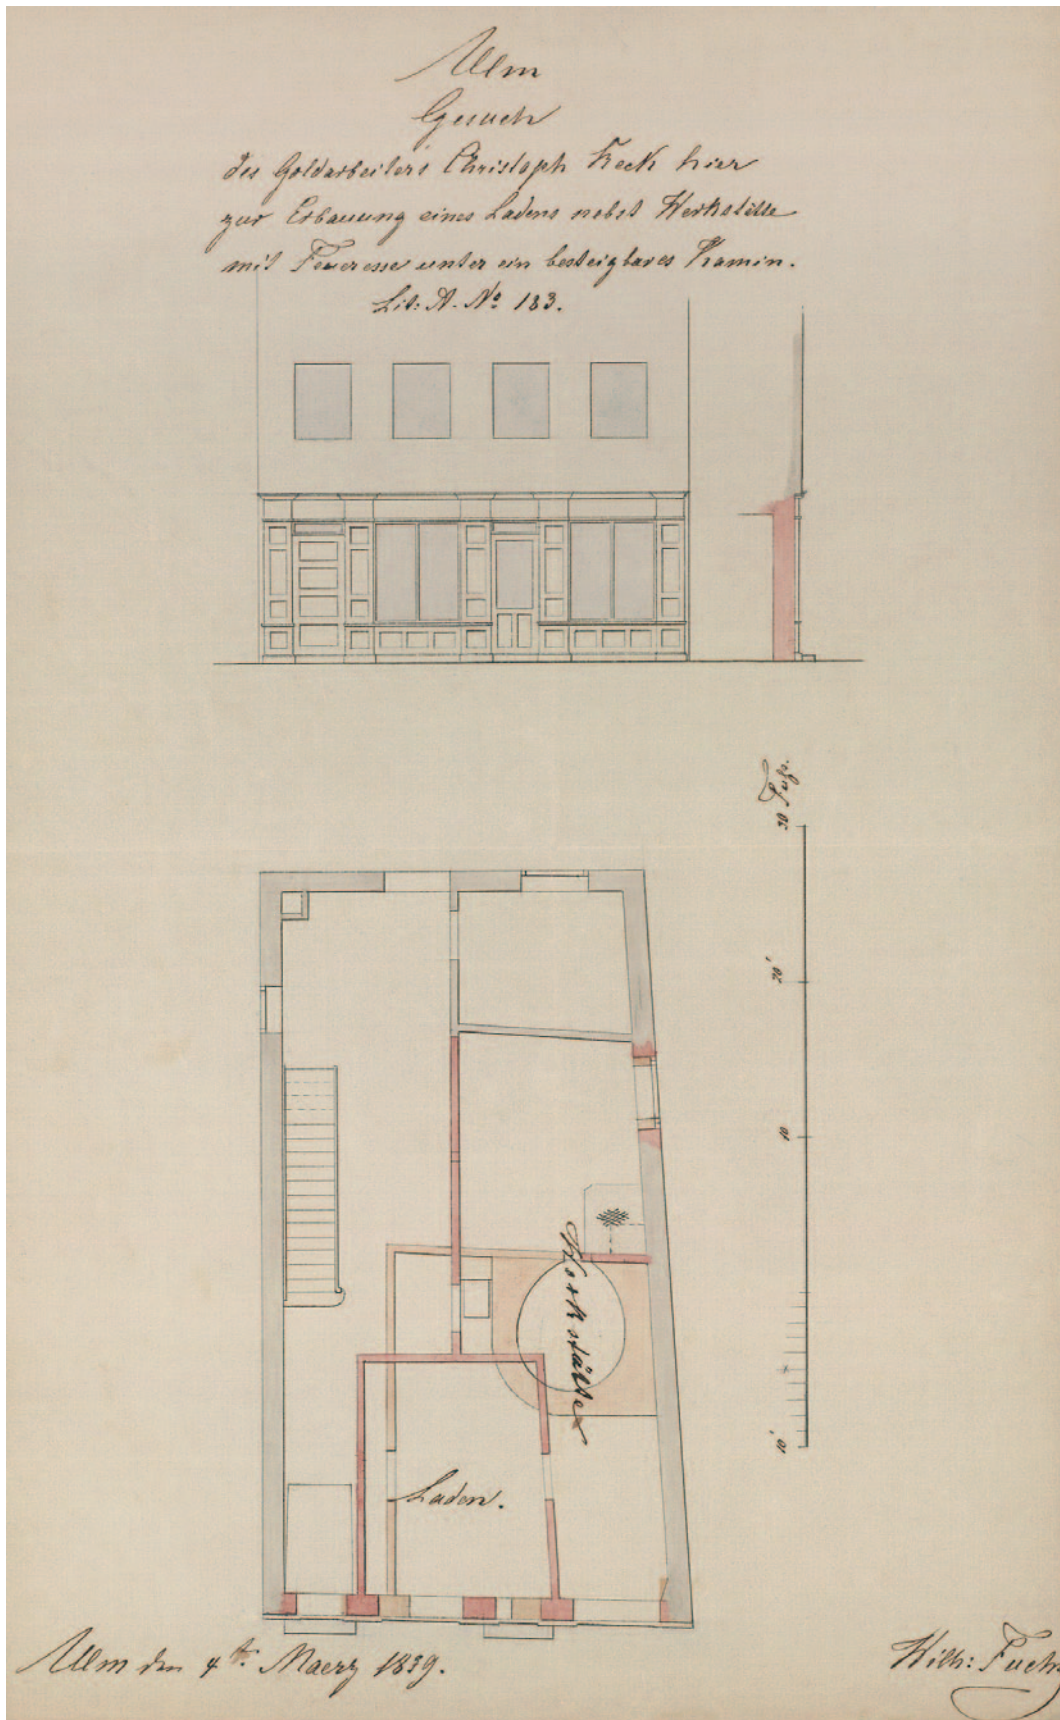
Gebäude Lange Straße 4 (A 183), Teilansicht und Erdgeschossgrundriss, Baugesuch 1859.
